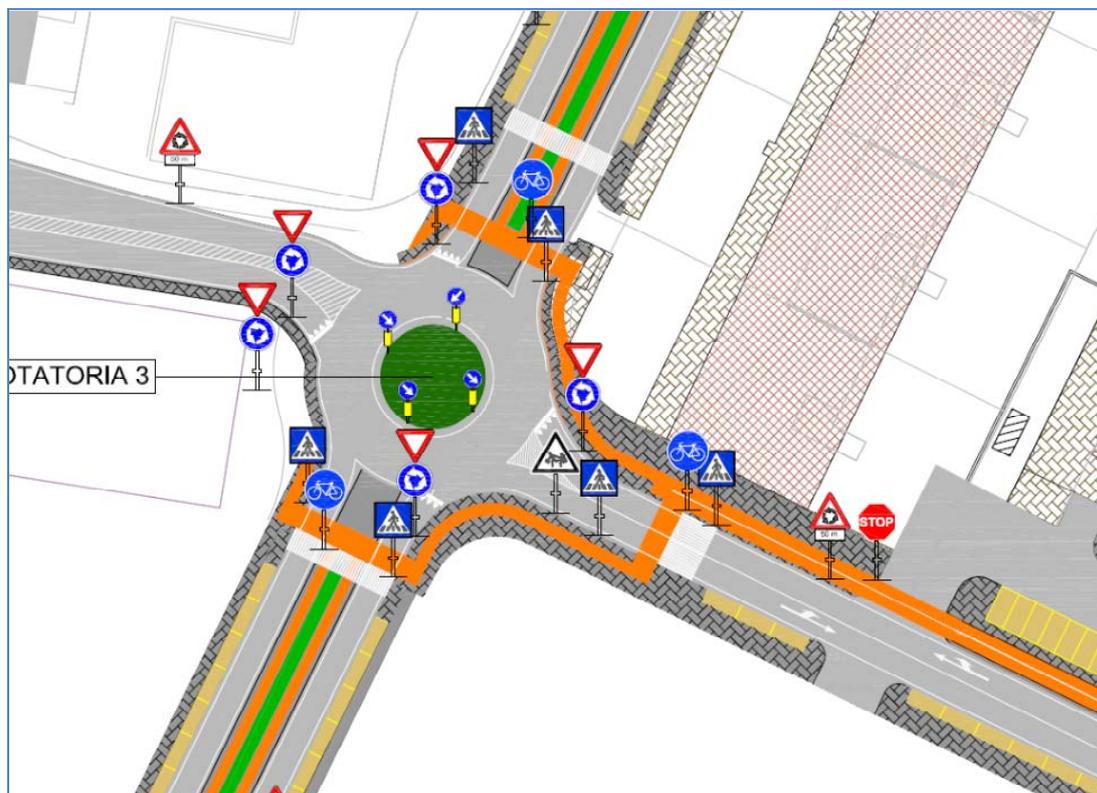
c Sistemazione tipo di rotonda - Rotonda intersezione Via A. Lattanzio - Asse 40, Asse 100
